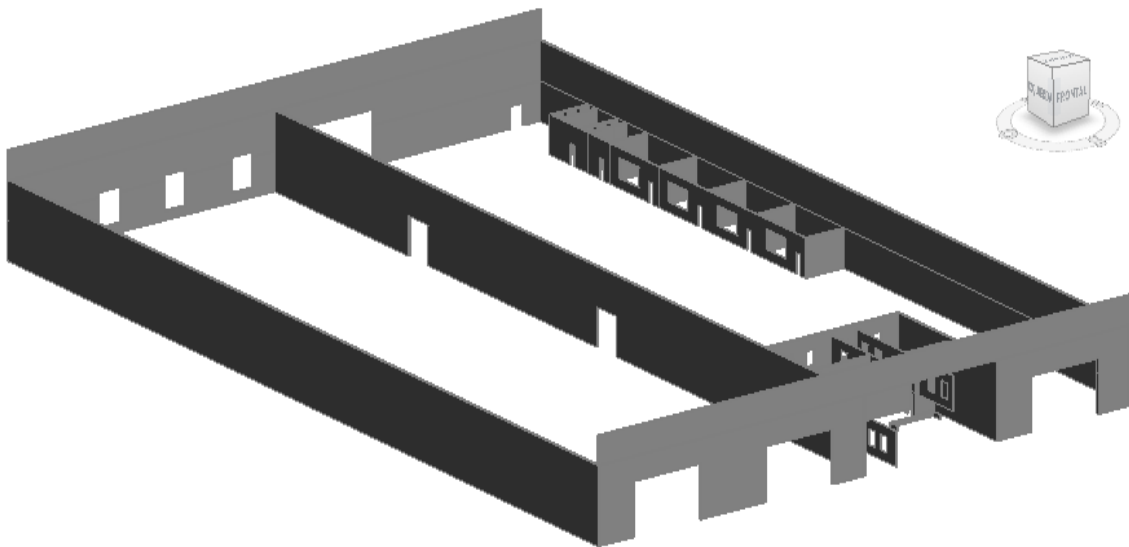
| MODELADO DE PAREDES “LOD 100” | Fuente propia
